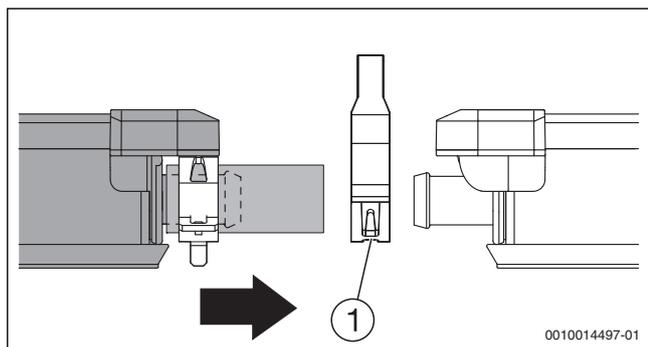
Spostamento del collettore sinistro verso il collettore destro
